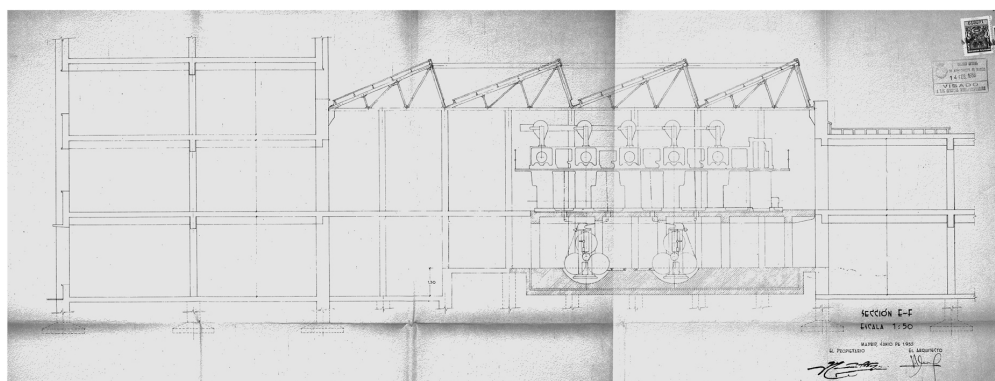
Sección transversal de la nave explicando la viga Shed múltiple. Fuente: Dibujo original de Víctor López Morales. AVM 42-474-33.
